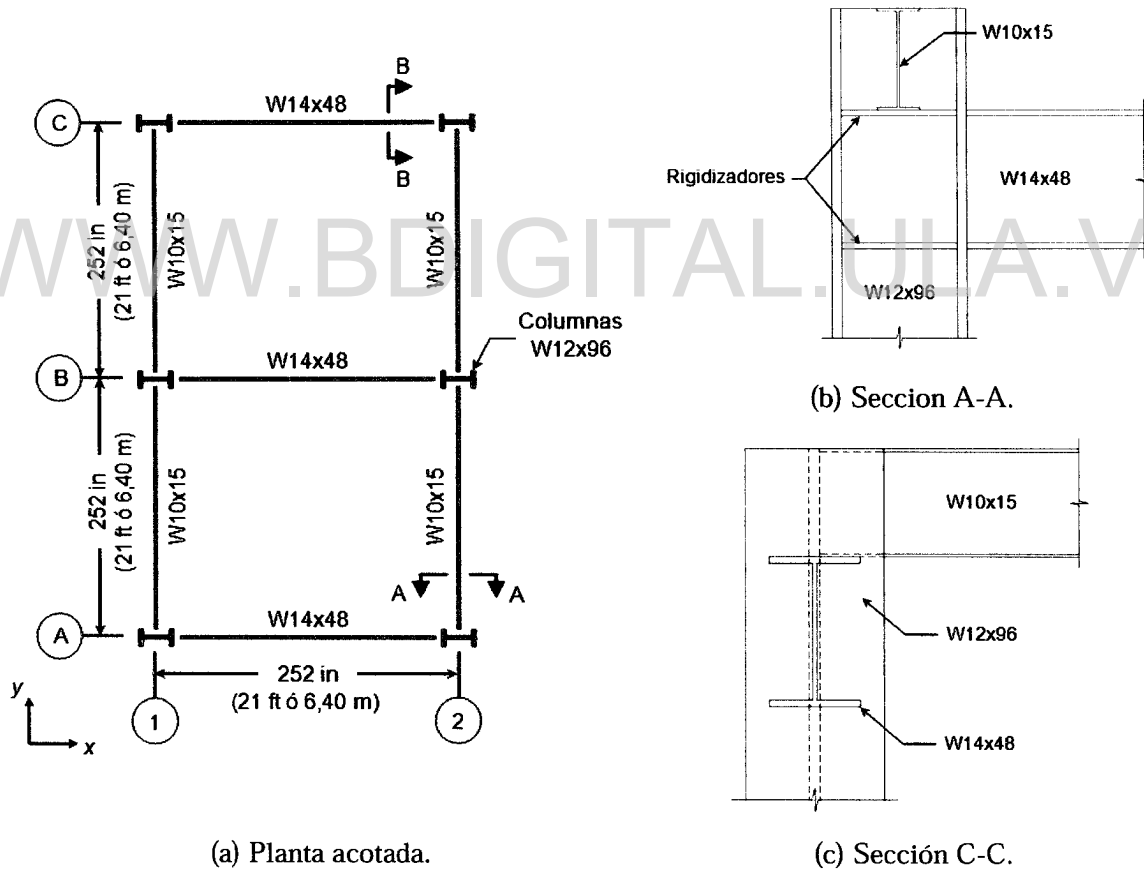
Planta acotada del sistema estructural y detalles de las conexiones en las columnas 2A y 2C.
